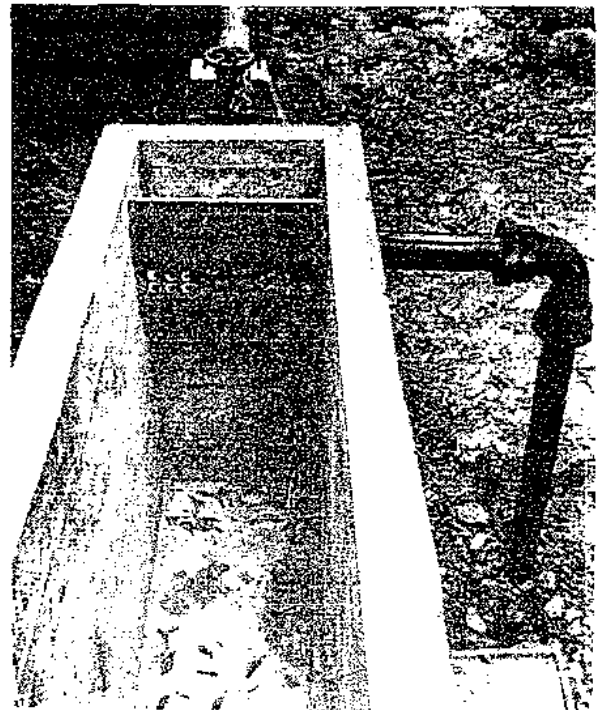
Vista interior de un desarenador, tubería de rebose y dispositivo de entrada.
